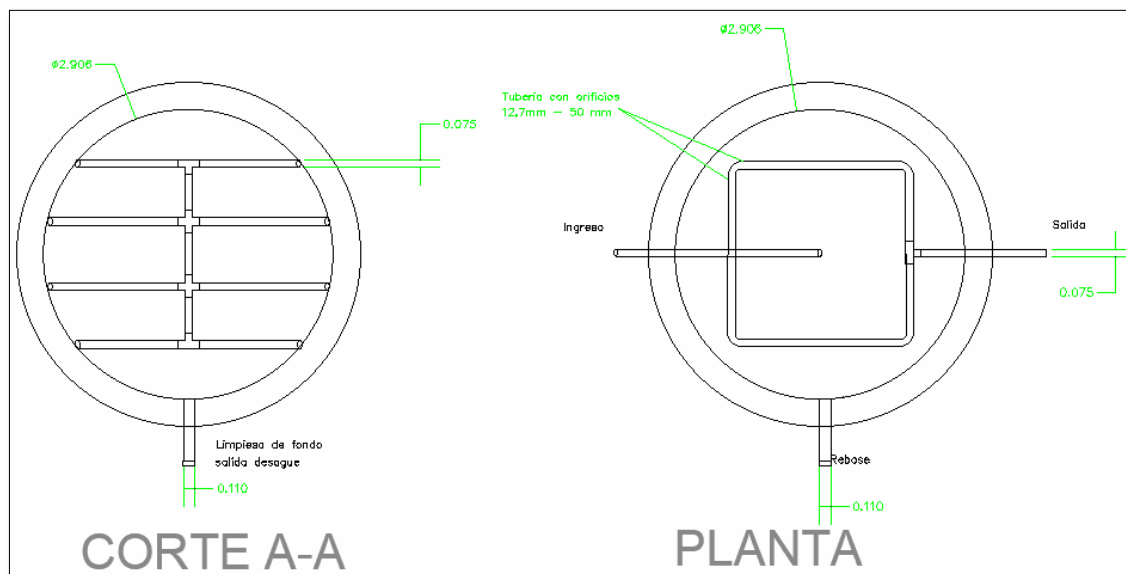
Filtro propuesto para el caudal futuro, vista en planta y corte A-A
